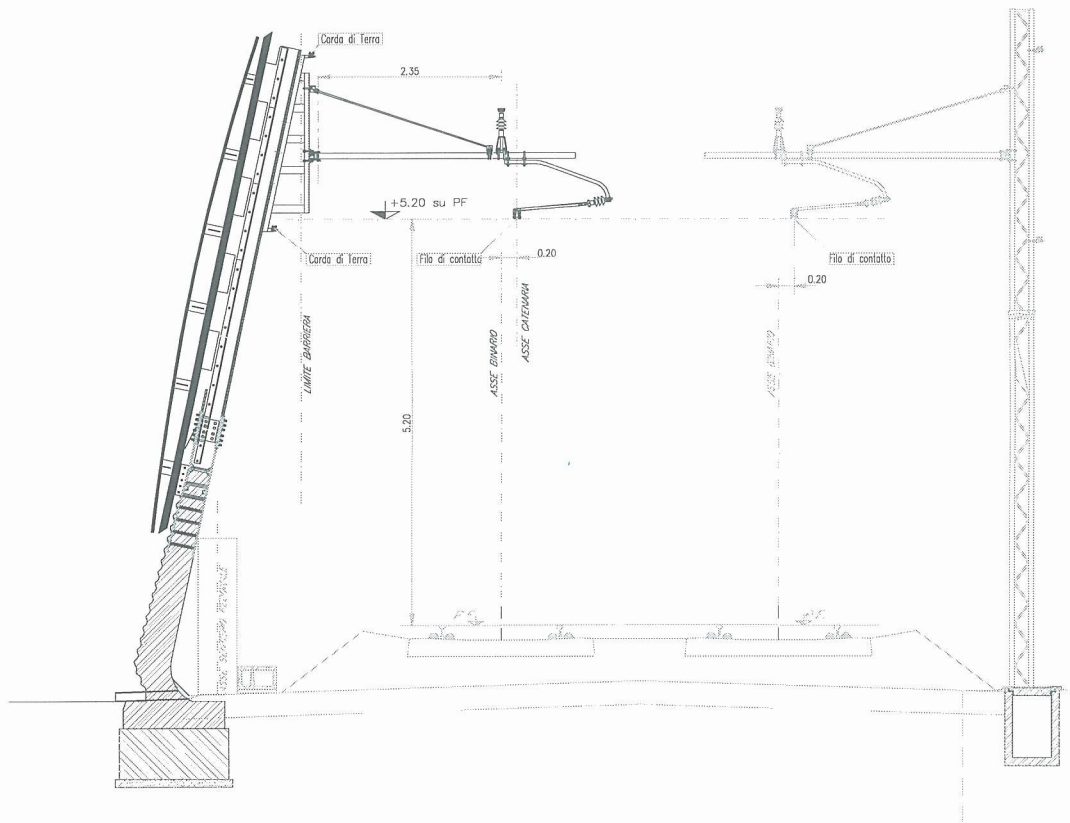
Sezione indicativa sospensione TE su barriera fonoassorbente
